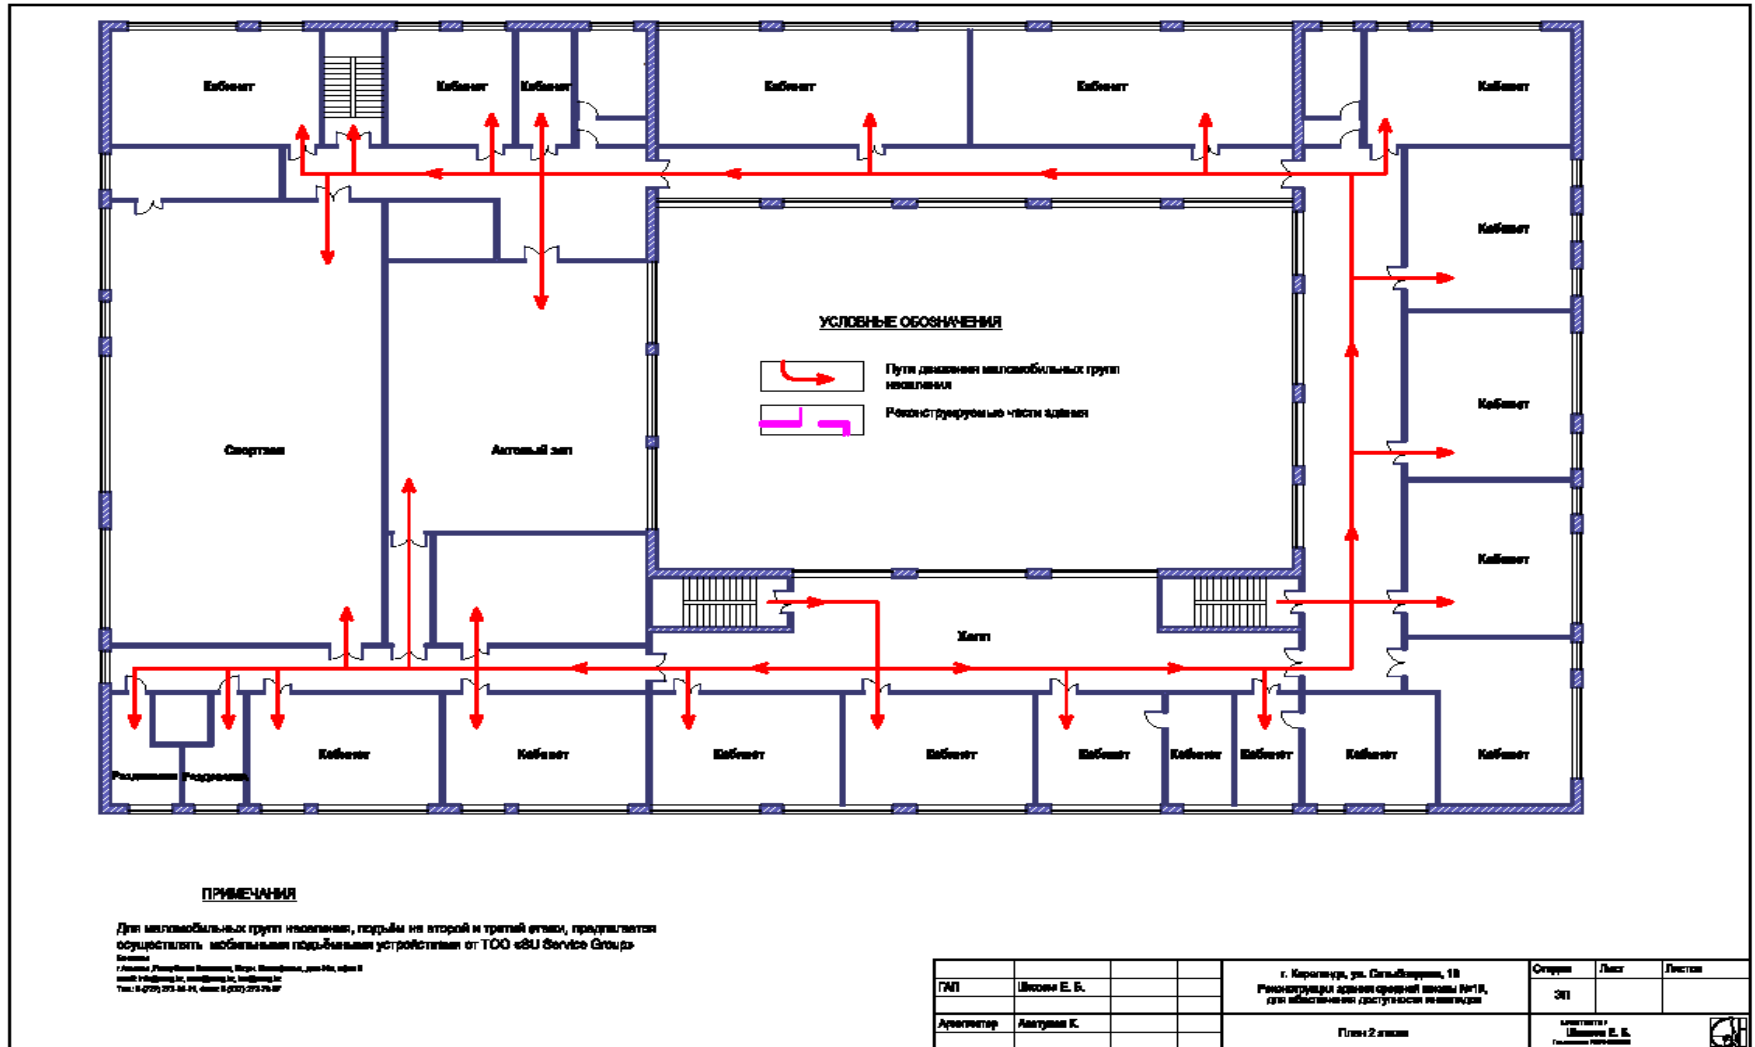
Архитектурный план реконструкции 2 этажа школы
